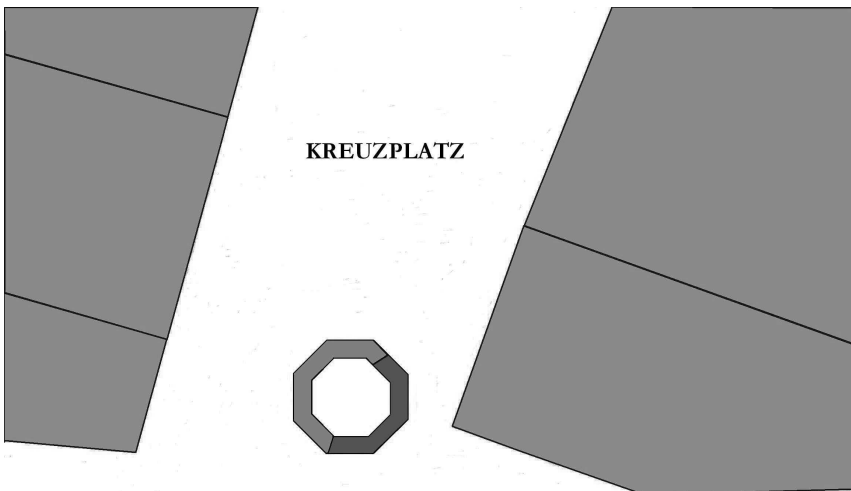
Grundrissplan des sechseckigen Bauwerkes (Turm) auf dem Kreuzplatz (dunkelgrau: erhalten; hellgrau: ergänzt) mit den Baugrenzen der Vorkriegsbebauung.
